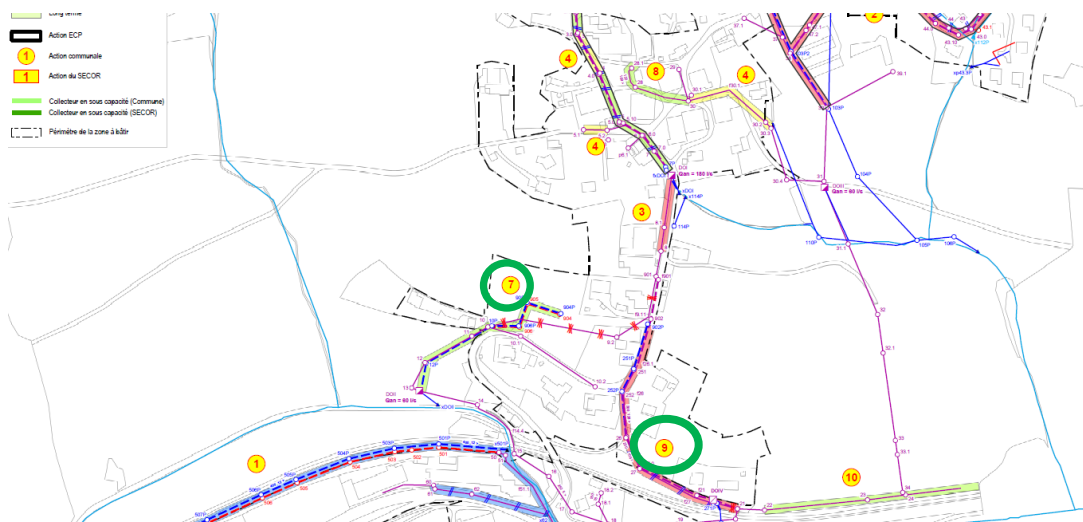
EXTRAIT DU PLAN D'ACTION DU PGEE
